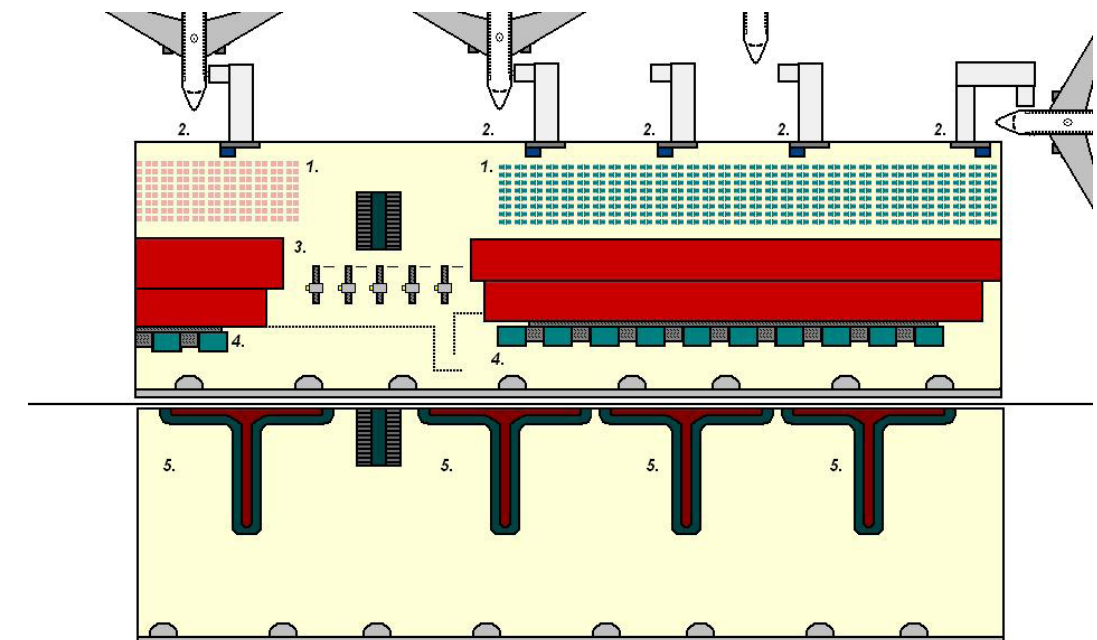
Planta tipo de una terminal | Fuente: Ohyeh, Wikipedia (2009).
